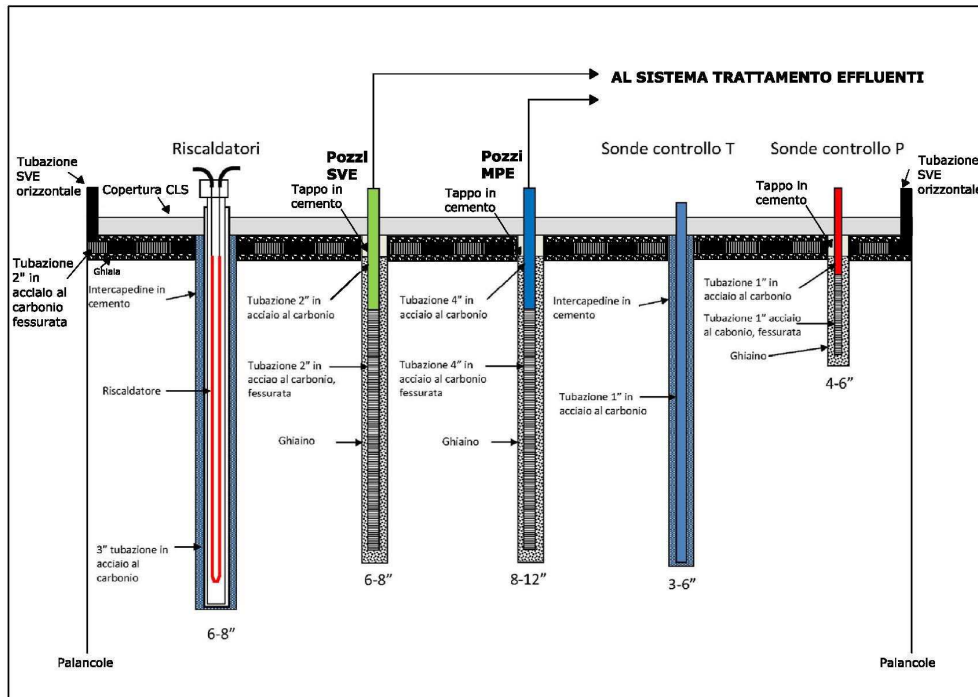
Schema del sistema di captazione ed estrazione contaminanti dalle aree di trattamento
